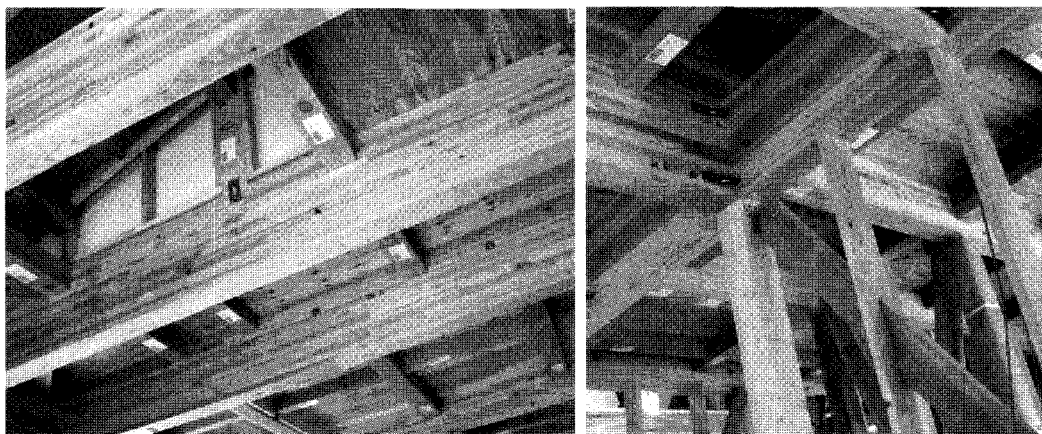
Chantier 2, sous-face du plancher de l'étage et détails des assemblages des poutres et des diagonales de contreventement
